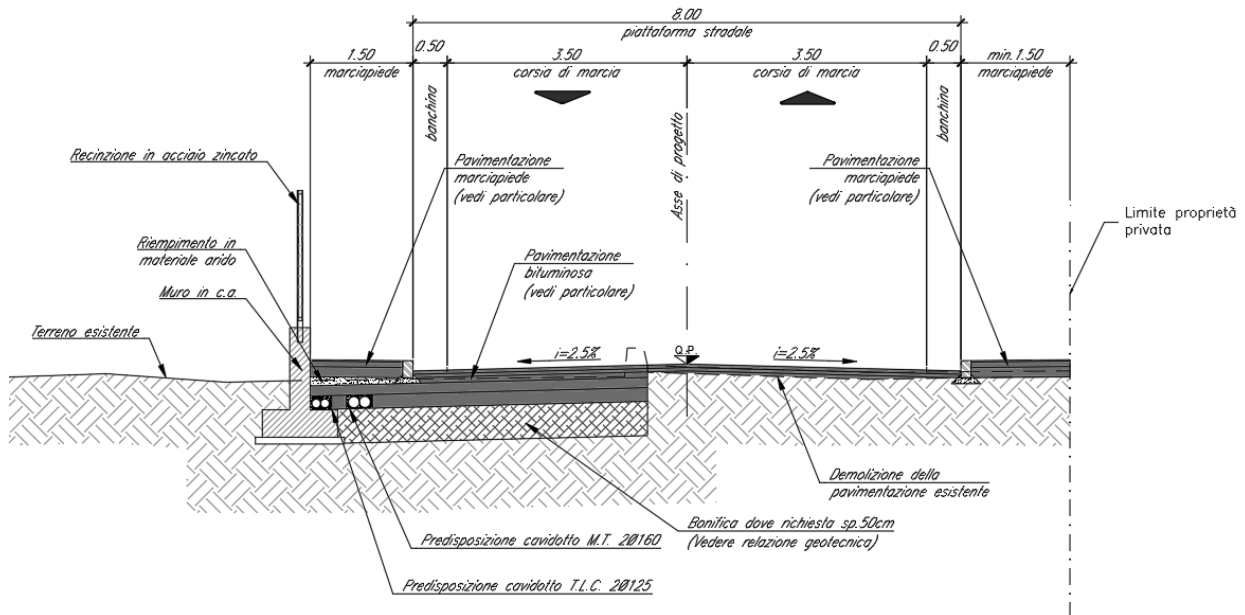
Sezione tipologica in rilevato con muro NV16 Asse 1
